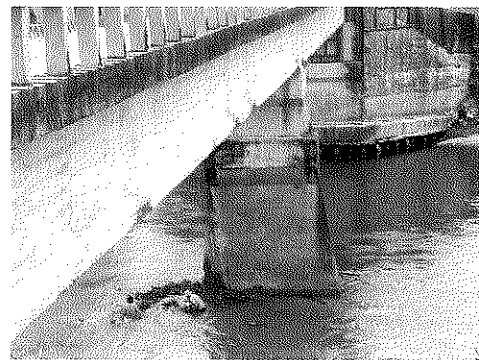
Puente Banadia. (Casanare) Puente que colapsó
